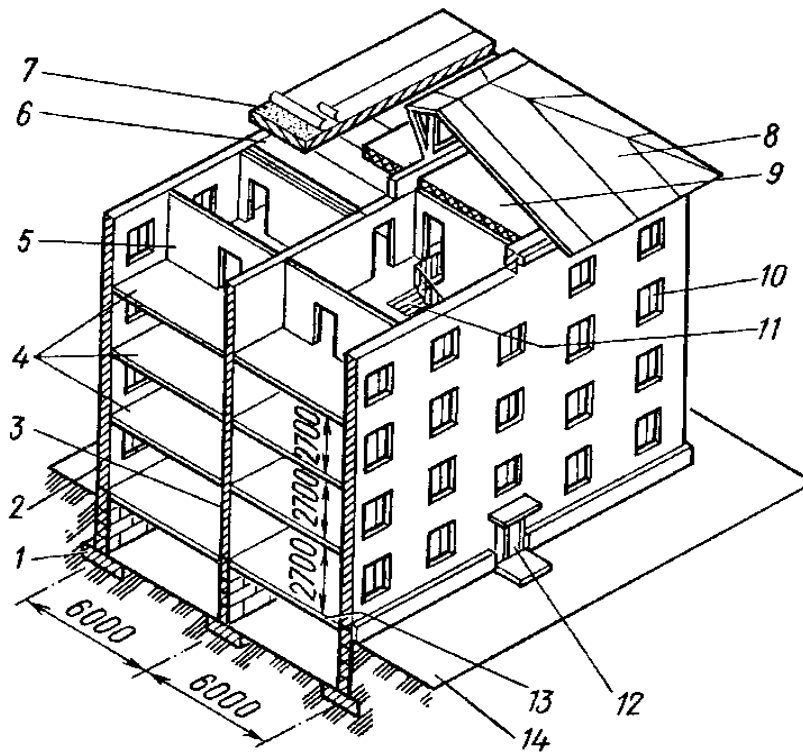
Основні конструктивні елементи будівлі: 1 – фундамент; 2, 3 – зовнішня і внутрішня стіна; 4 – міжповерхові перекриття; 5 – перегородка; 6 – верхнє покриття; 7, 8 – безгорищні і горищні дахи; 9 – горищне перекриття; 10 – вікно; 11 – сходи; 12 – входні двері; 13 – надпідвальне перекриття; 14 – вимощення
